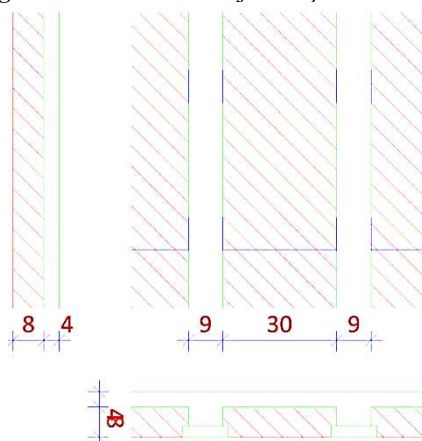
Detalhe da laje treliçada com EPS na planta de forma.
